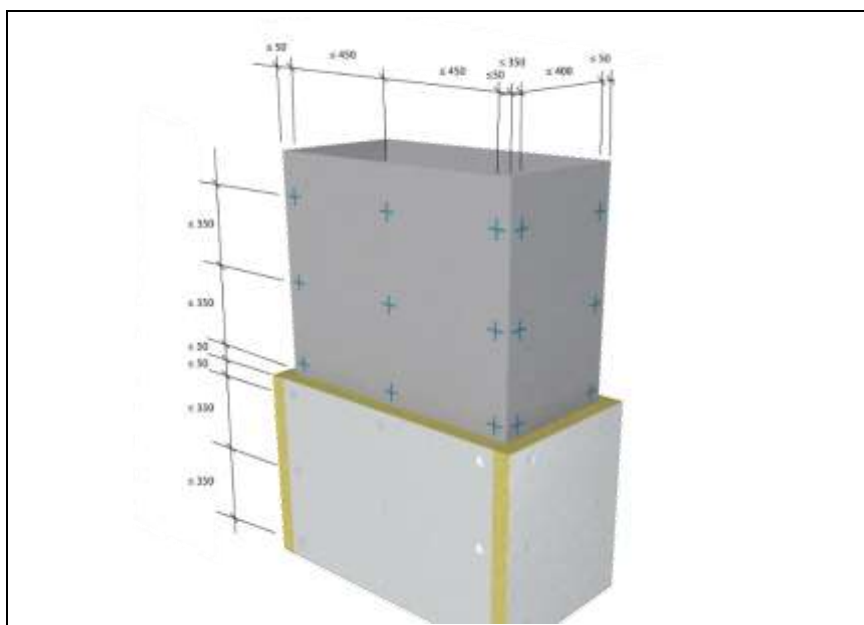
Detalle de la posición de los pins soldados.
